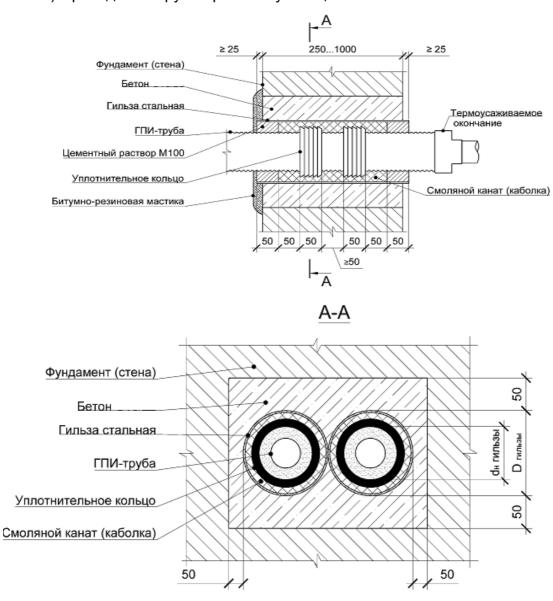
Узел прохода ГПИ-труб через строительные конструкции
